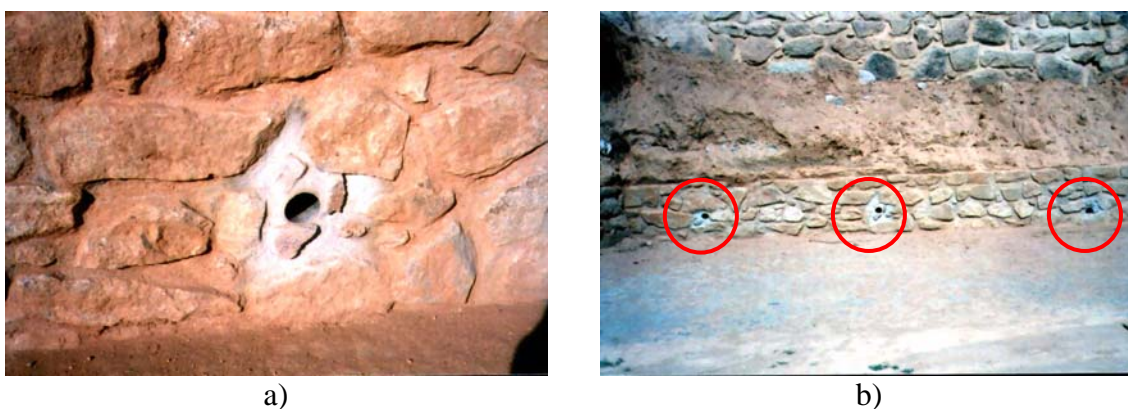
[4e]: Tubagens de drenagem para o exterior, junto à fundação da muralha
